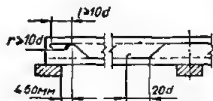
Конструкция отгиба неармируемой арматуры.
